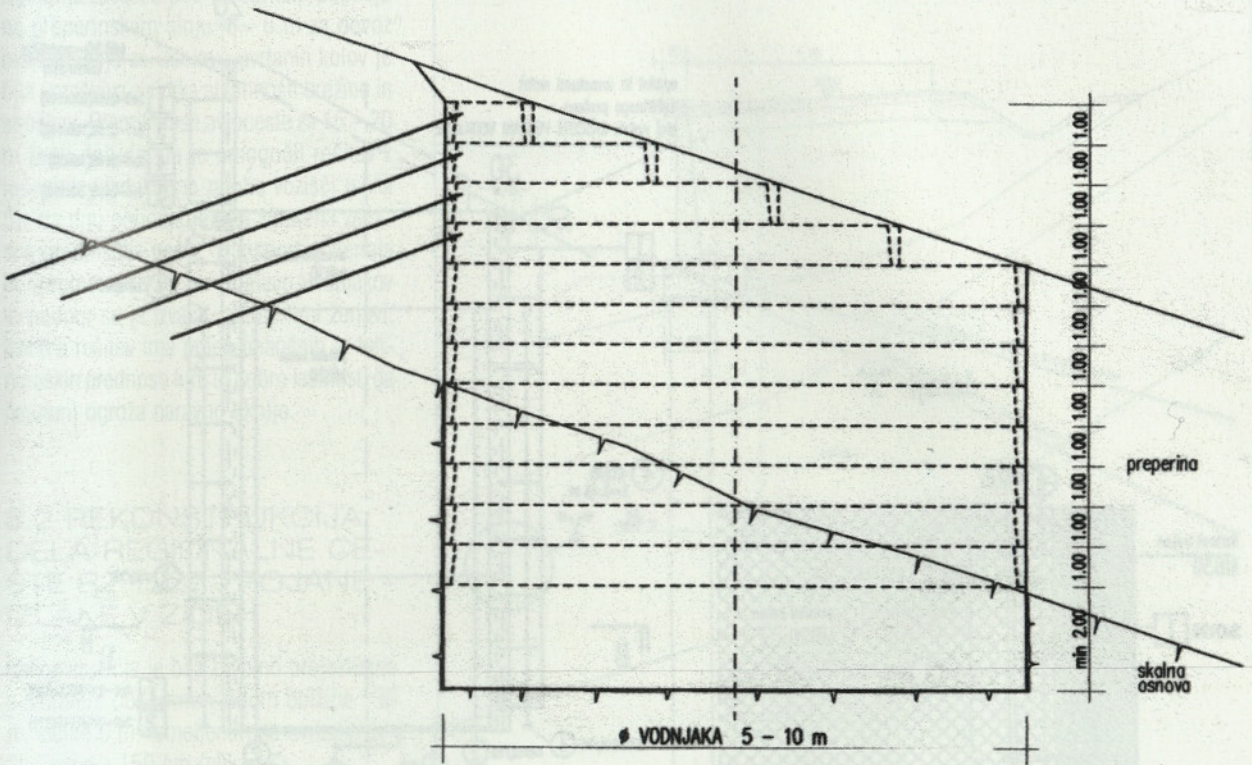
Vodnjak na strmem pobočju premera 9,0 m, višine 6 – 15 m, varovan z armiranobetonskimi obroči višine 1,0 m, debeline 20 – 30 cm, pri viaduktu Ločica - Trojane
